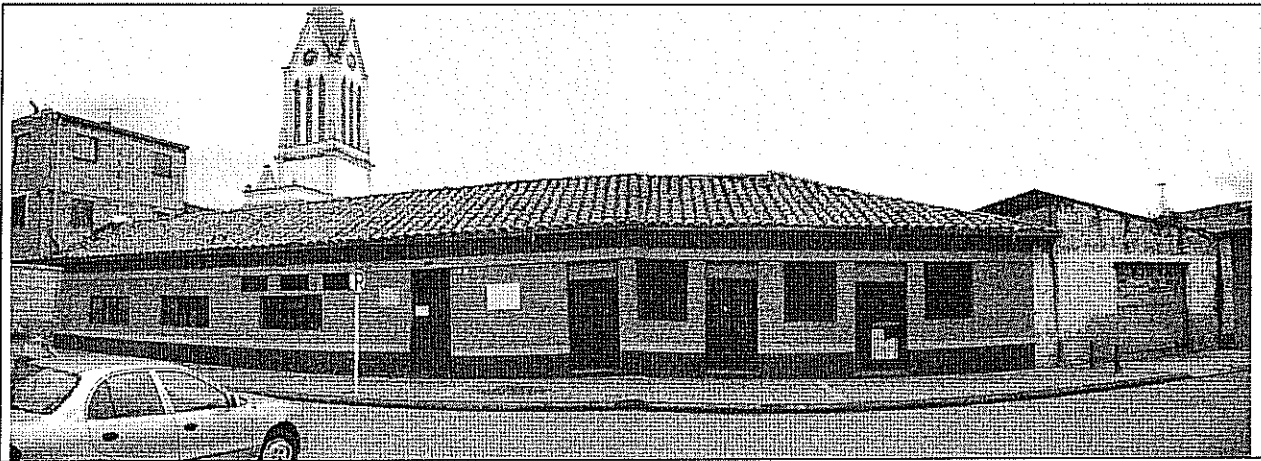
Vista general, desde la Calle 19A, de la edificación de un (1) nivel con forma en planta de L, localizada hacia el sector norte del predio de la Calle 19A No. 32-41. Al fondo, la torre del templo Parroquial de San Gregorio Magno.
